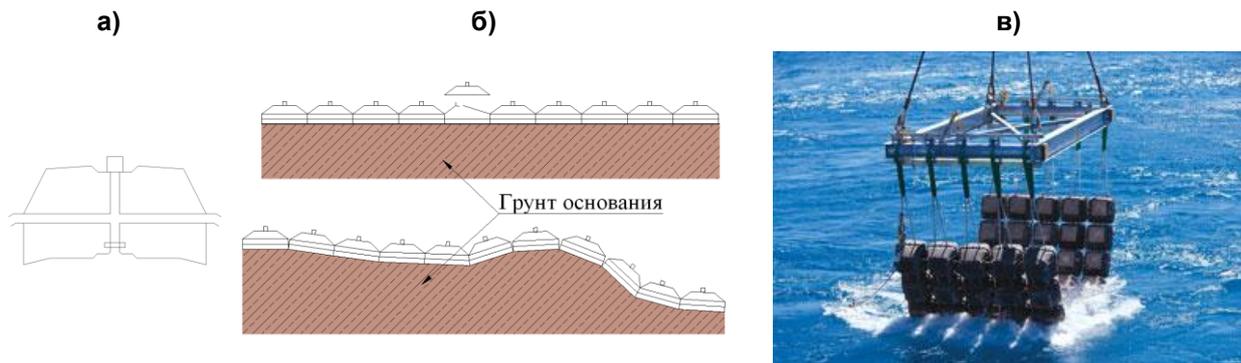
Система защиты дна в виде сборных покрытий: а – бетонный элемент; б – ковер из бетонных элементов; в – укладка покрытий из сборных матов
